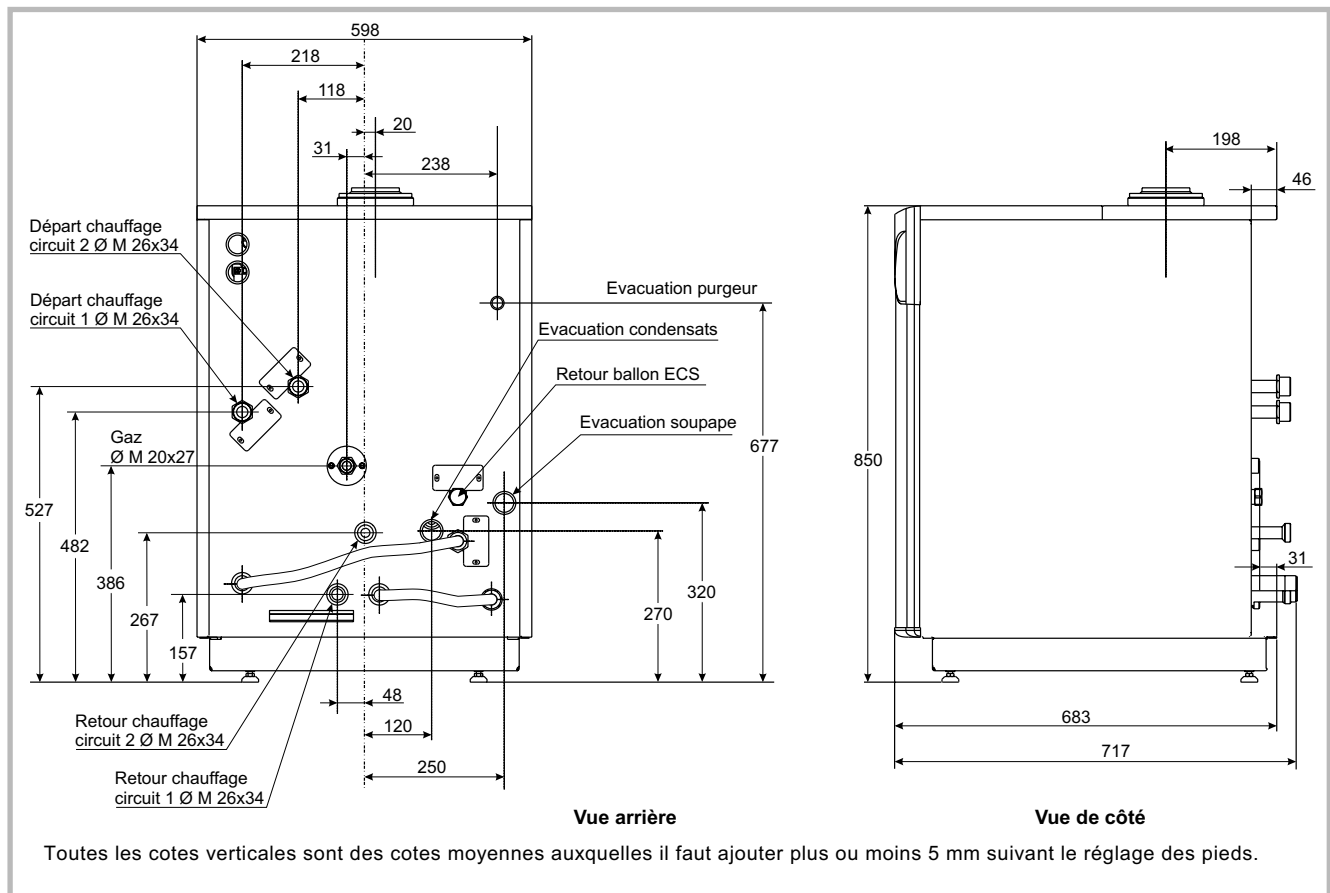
Dimensions en mm (avec kit hydraulique 2 circuits)
